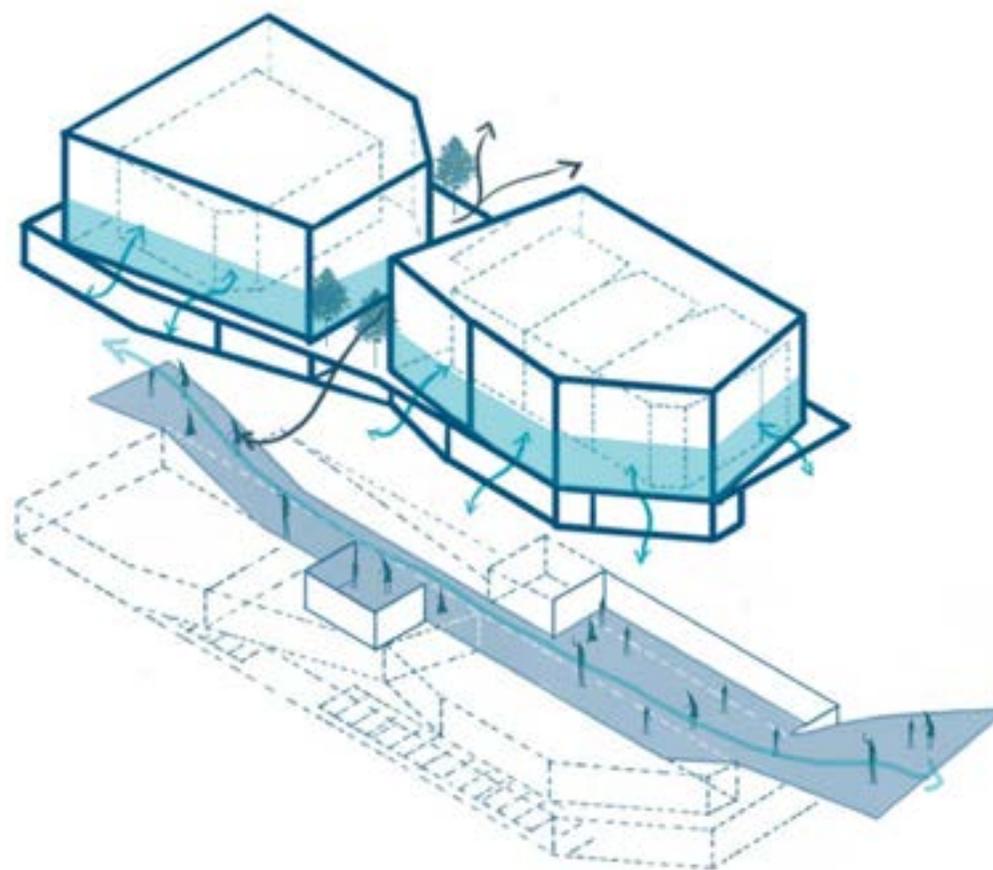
Vinculación del equipamiento en planta baja con su contexto urbano. Fuente: Autoría Propia
